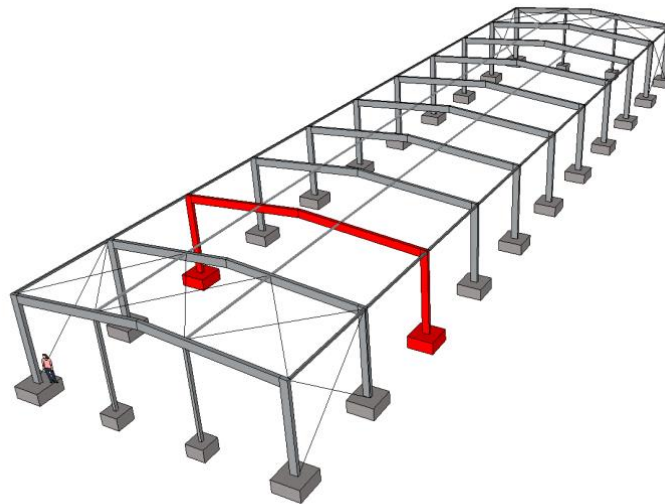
Isometrie einer Hallenkonstruktion mit der betrachteten Rahmenkonstruktion
